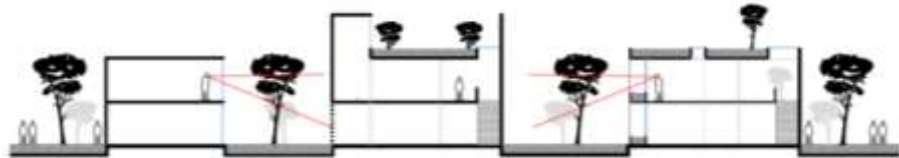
Dispositivos de protección solar interior en comedor de luz, galería comercial, Santiago.
